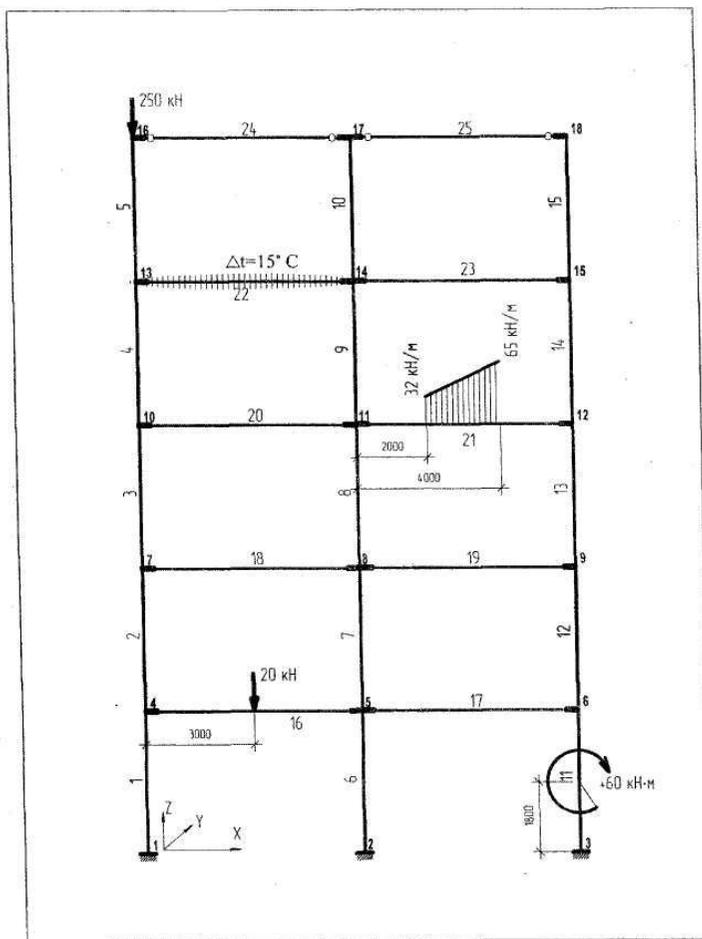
Узловые и местные нагрузки на раму (3-я схема)
